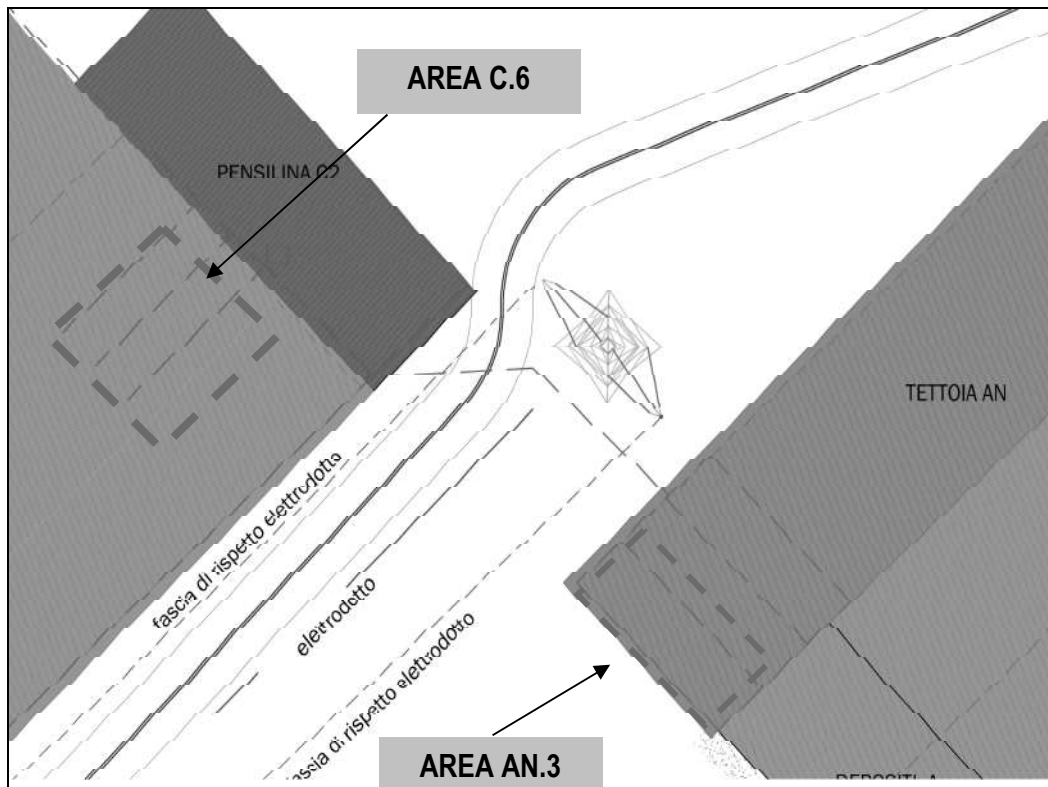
Stralcio planimetria di sviluppo impianto a barriera osmogenica
